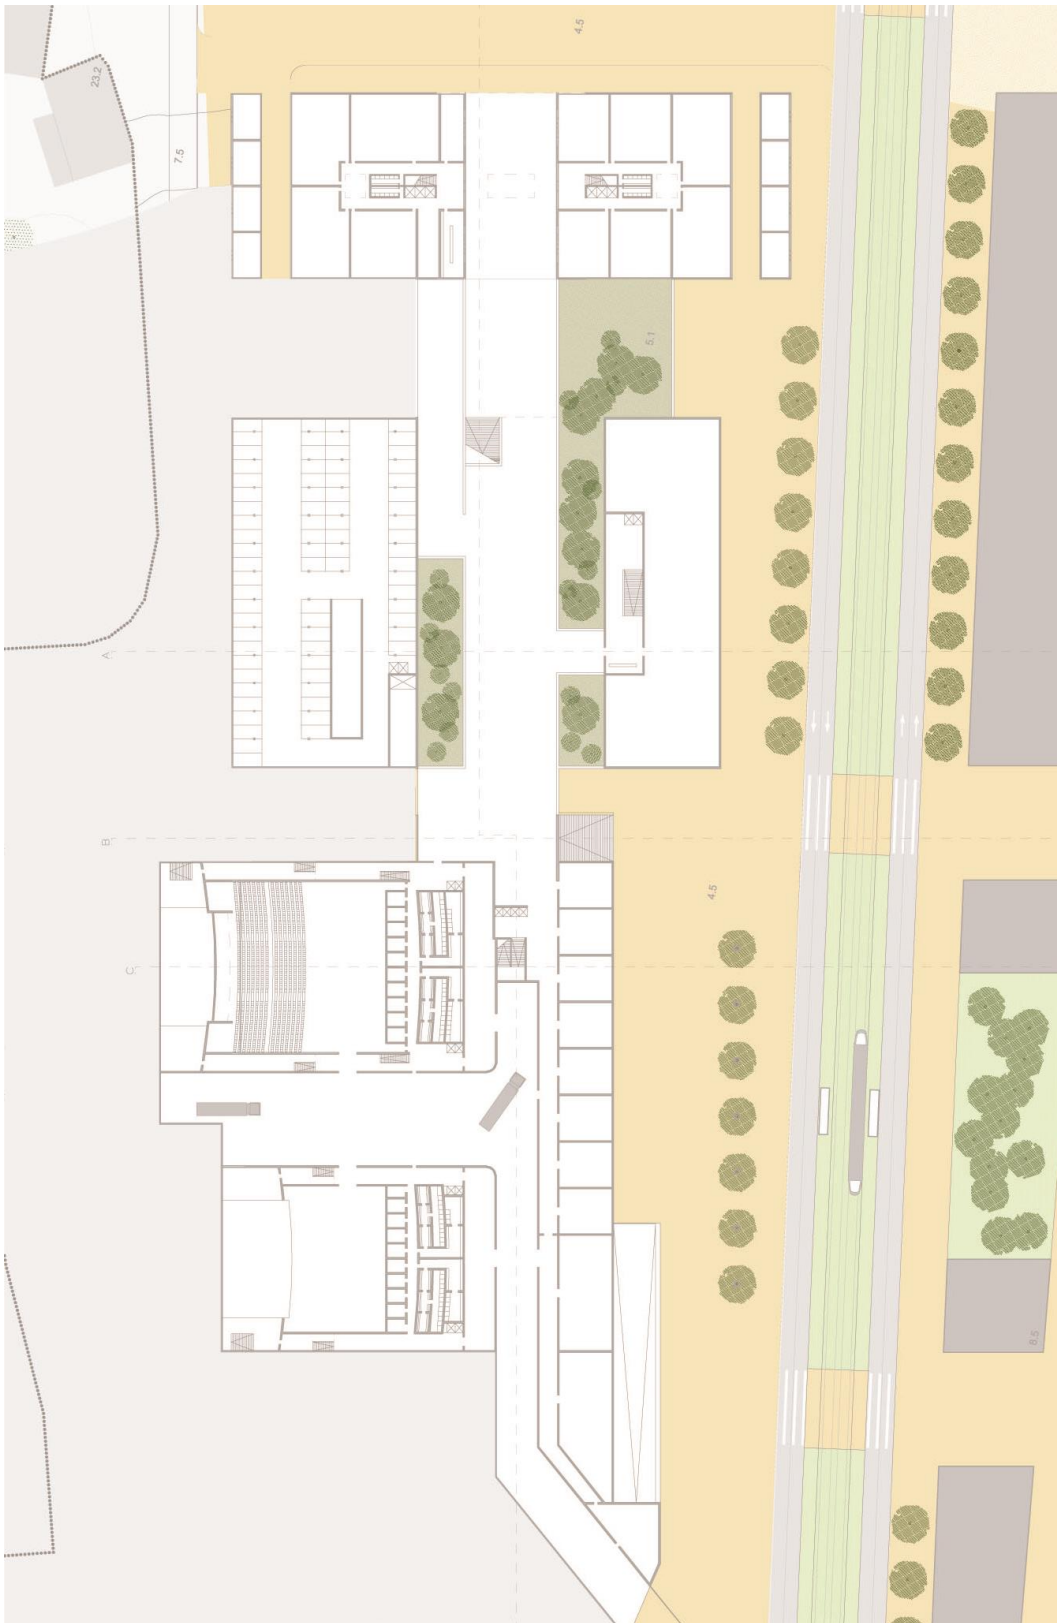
Planta piso 0/1, cota 7.5. Fonte: Autora
